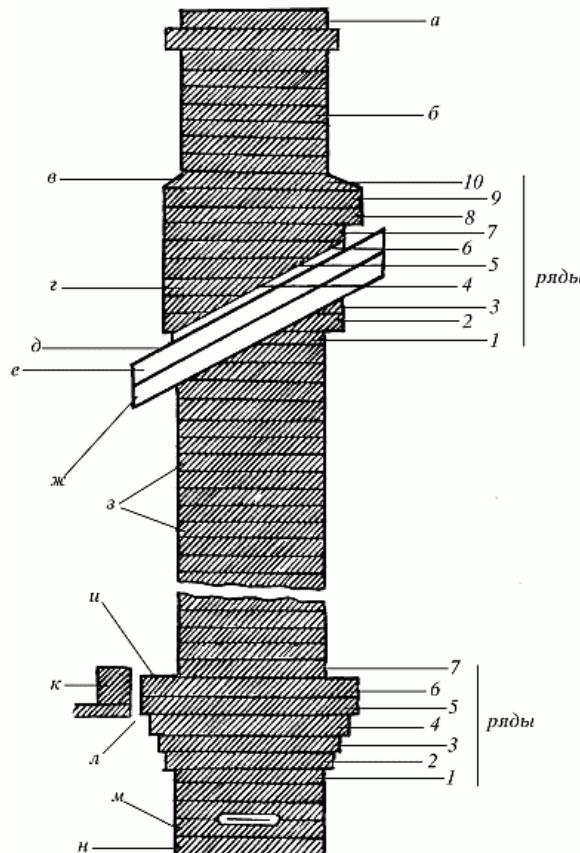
Устройство дымовой трубы: а — оголовок трубы; б — шейка трубы; в — цементный раствор; г — выдра; д — кровля; е — обрешетка; ж — стропила; з — стояк трубы; и — расpushка; к — балка с перекрытием; л — изоляция; м — дымовая задвижка; н — шейка печи
